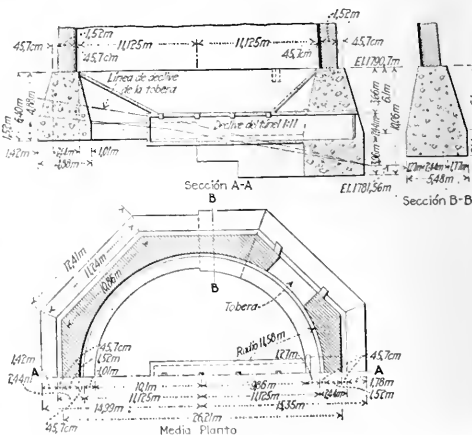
SECCIÓN Y PLANO DE LOS CIMIENTOS
